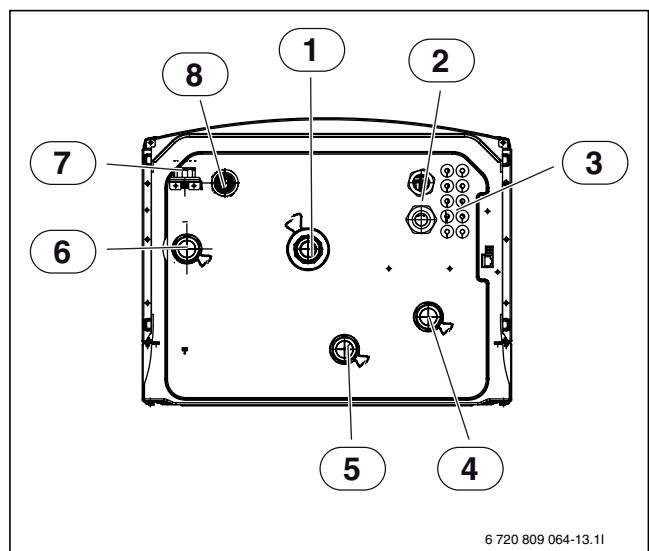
Трубные подключения внутреннего блока AWE с электрическим нагревателем (вид снизу)
